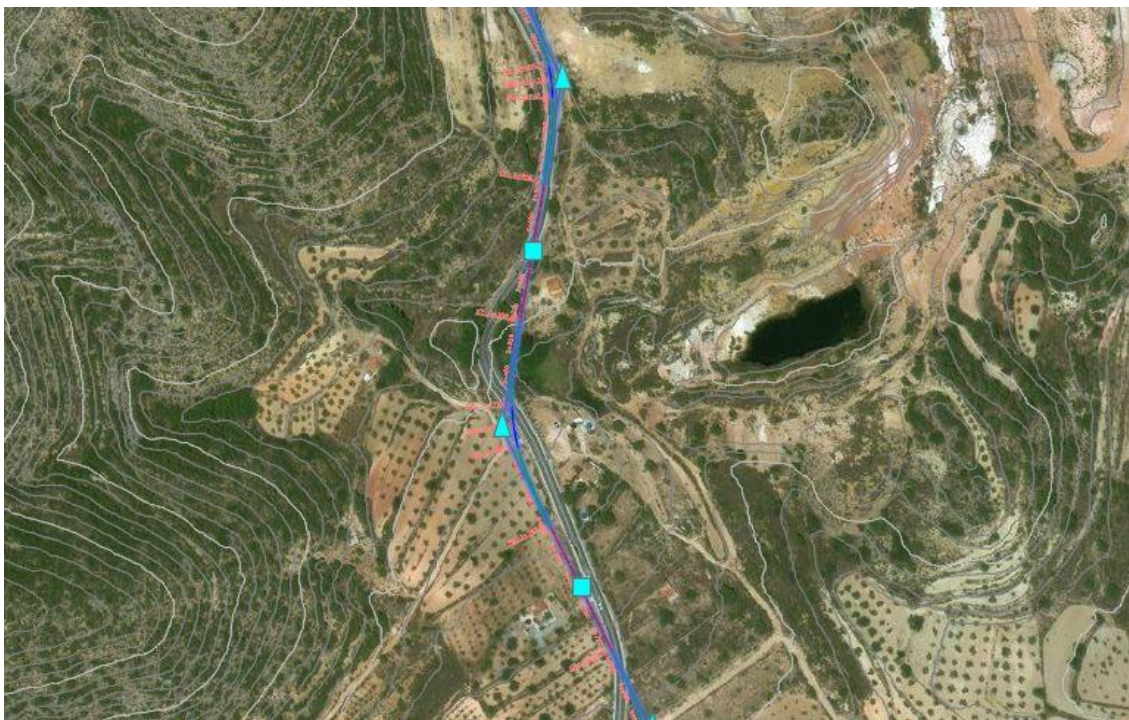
Propuesta de trazado en planta, curva 11. Fuente, CIVIL 3D.
